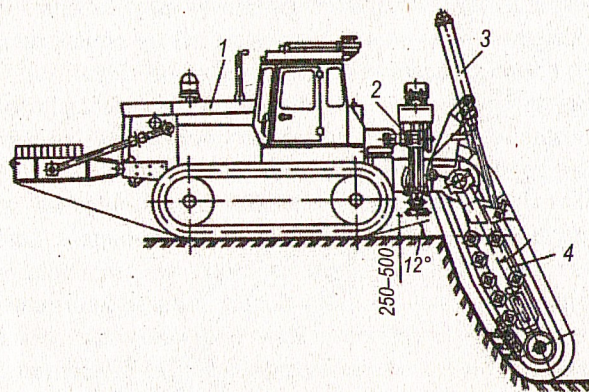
Цепной многоковшовый экскаватор: 1 — базовая машина; 2 — цепной скребковый конвейер; 3 — гидроцилиндр подъема и опускания рабочего органа; 4 — рабочий орган
